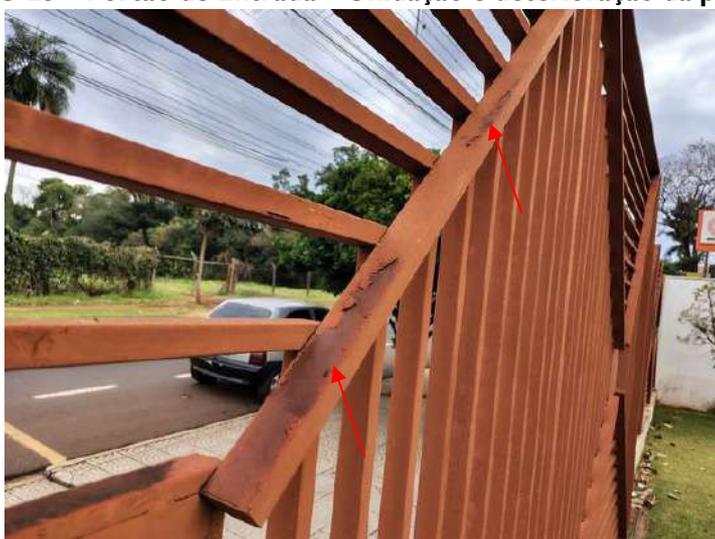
Portão de Entrada – Oxidação e deterioração da pintura
